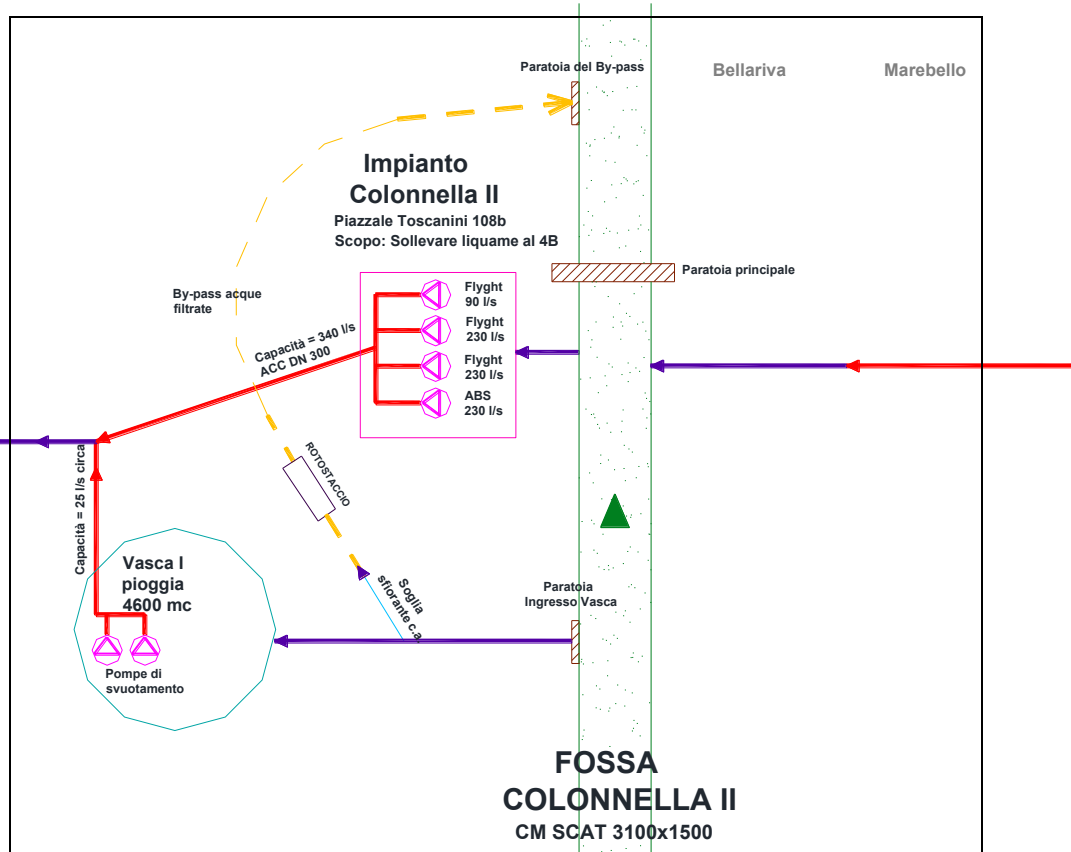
Schema planimetrico del tratto terminale della fossa Colonnella II
